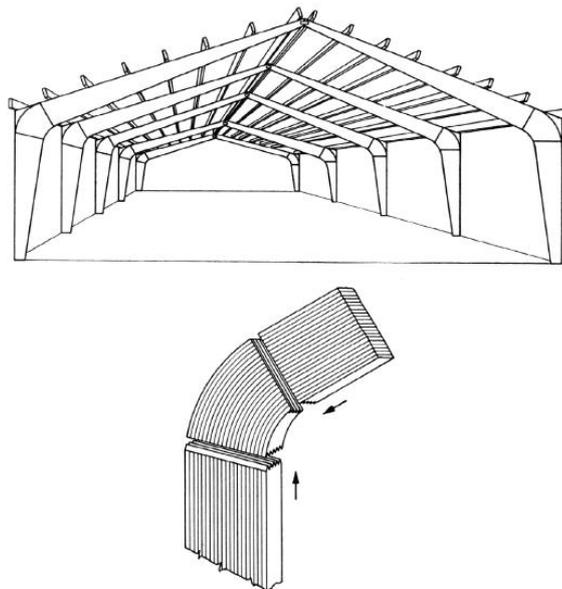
Hall à usages divers : poutres droites (portée de 10 à 25 m) et détail d'assemblage d'angle à entures multiples.
